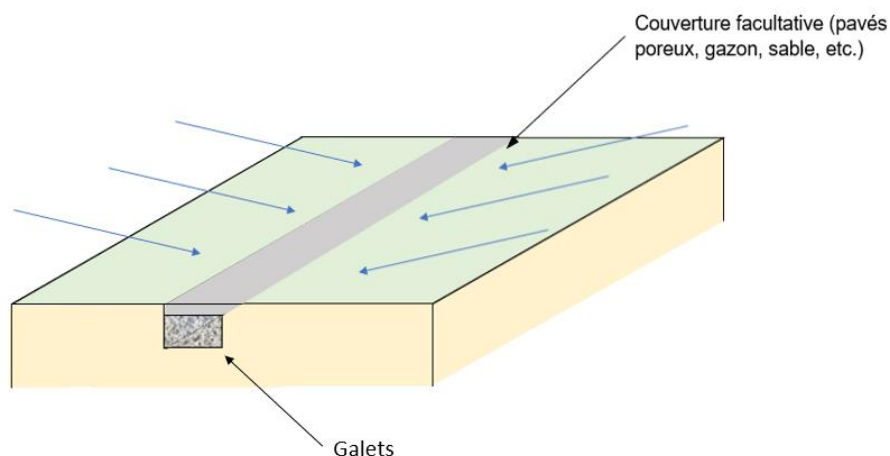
Tranchée infiltrante, A. Foucher (2021)
